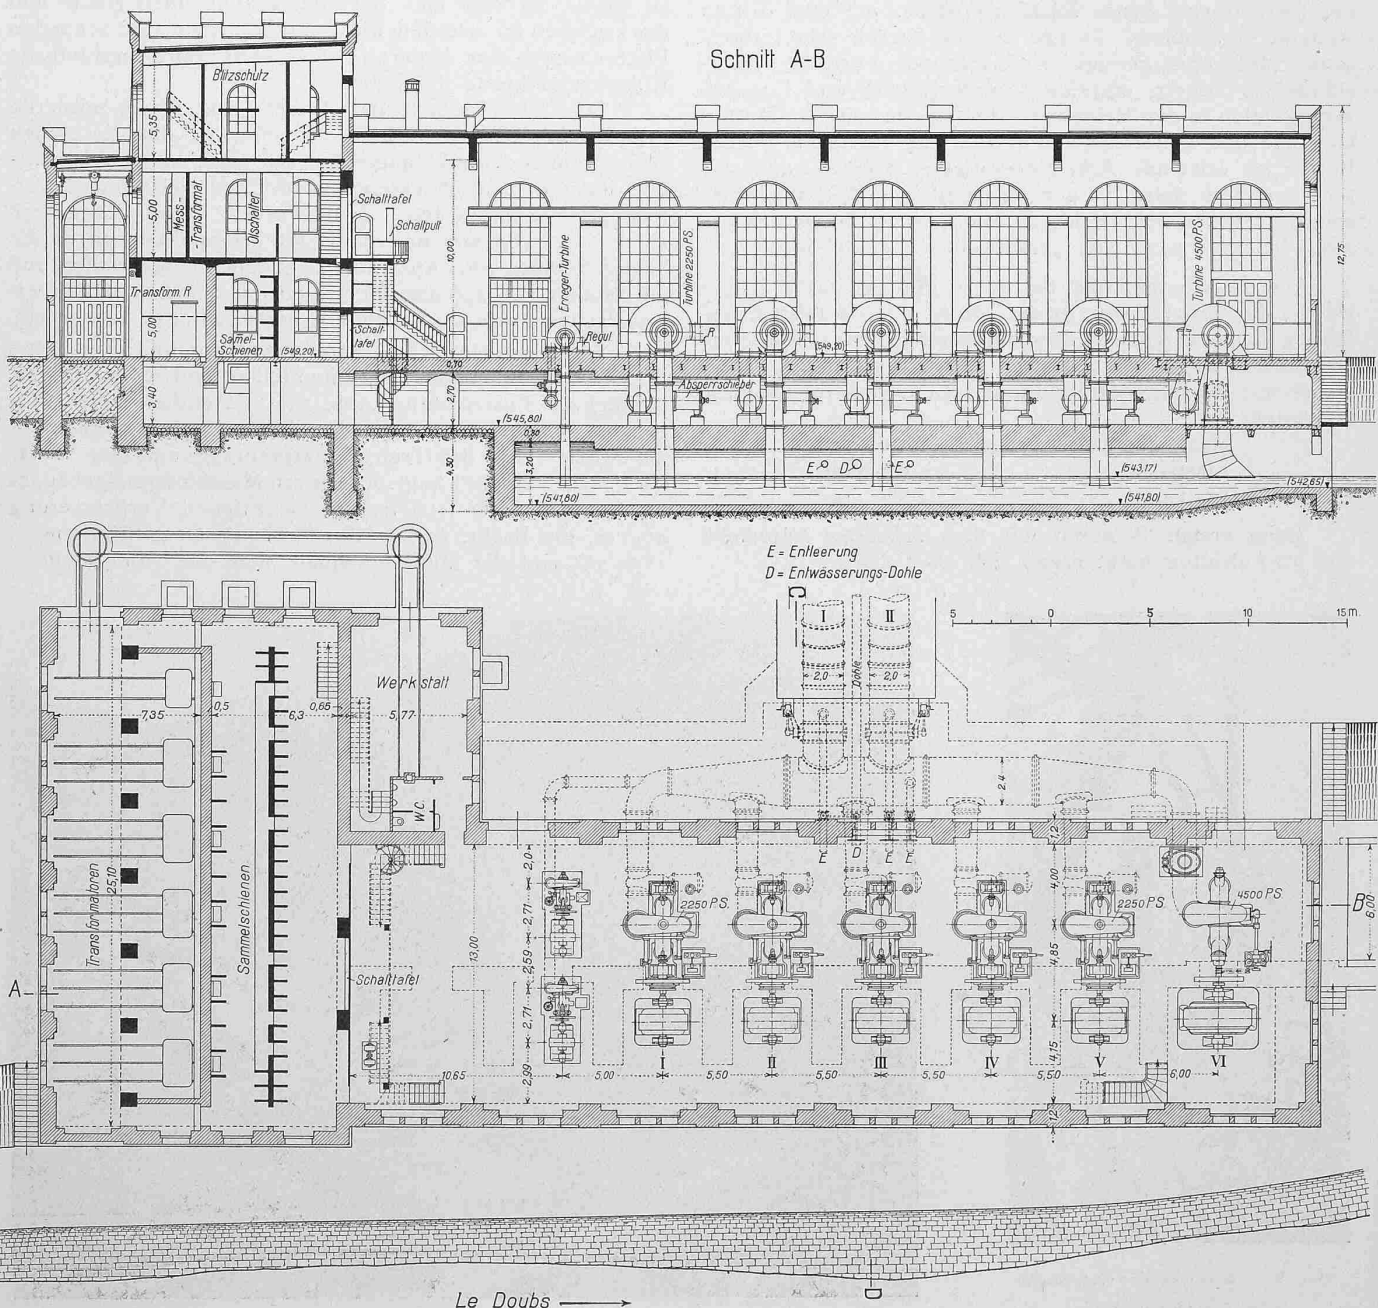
u. 17. Grundriss und Längsschnitt A-B der Zentrale. — Masstab 1 : 350 (Schnitt C-D siehe Abb. 13 auf S. 189 letzter Nr.).
